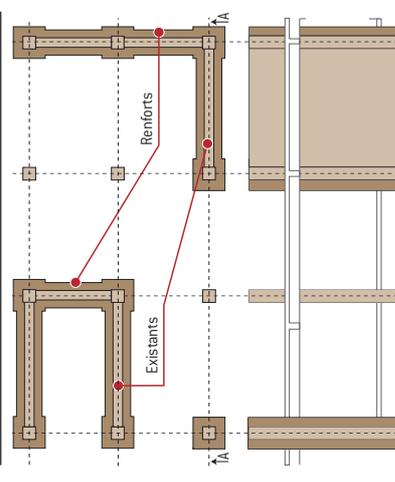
Exemple de renforcement de poteaux, murs, par chemisage en béton projeté (vue en plan et coupe AA')
